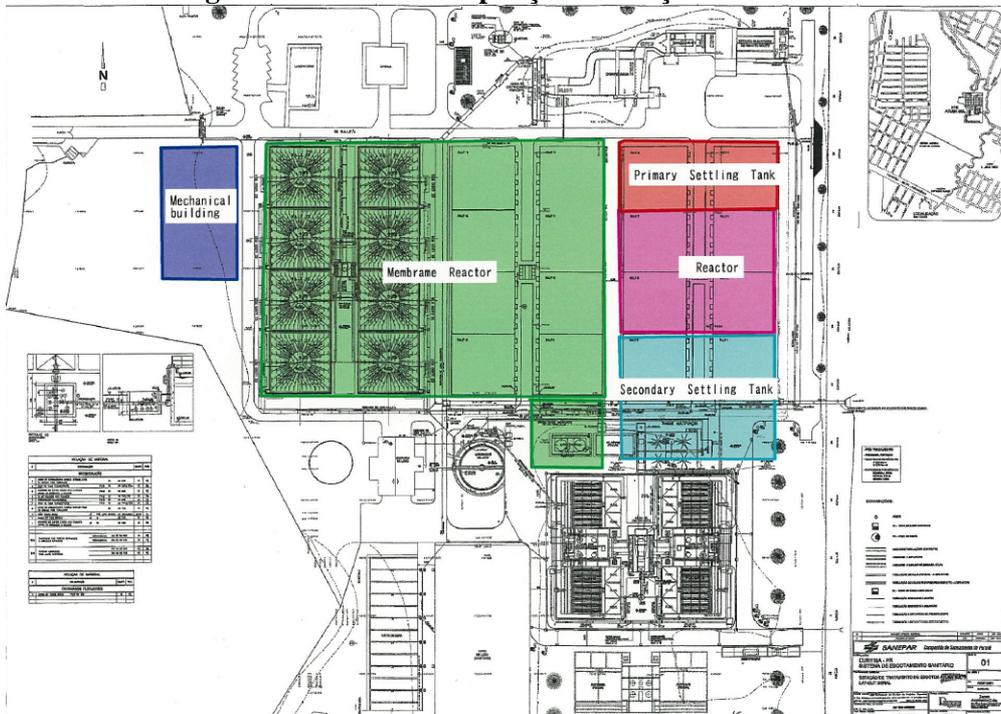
Plano de disposição da estação de Atuba Sul
